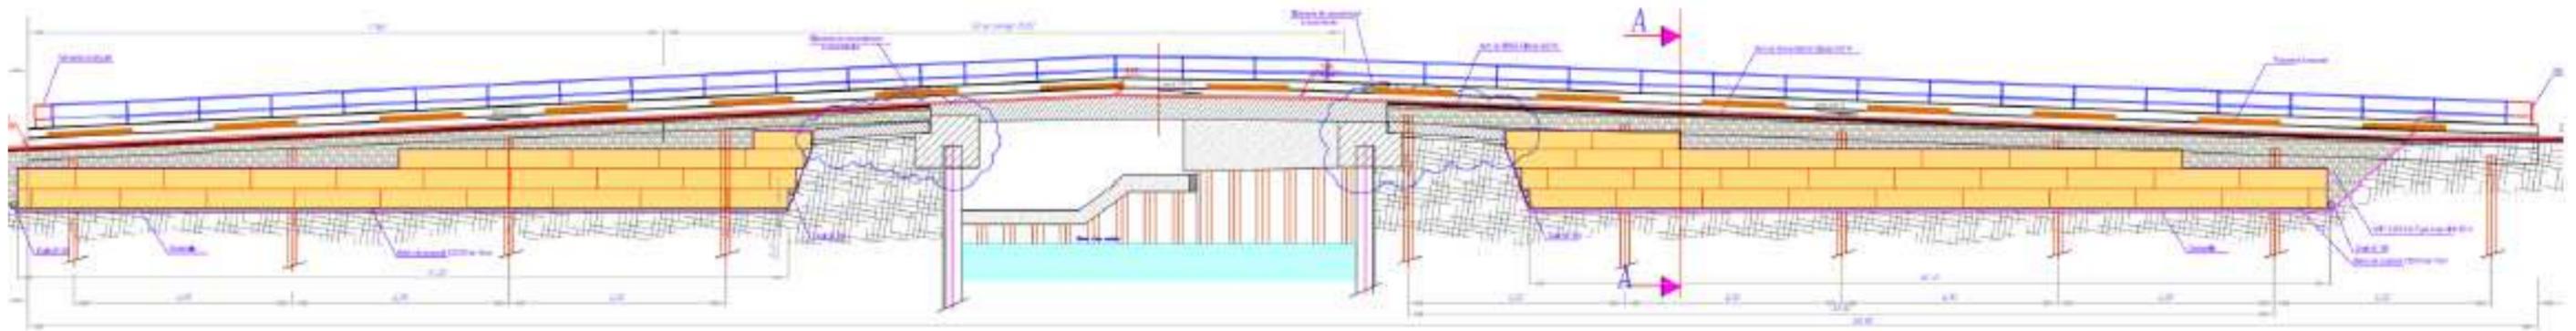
coupe longitudinale de l'ouvrage solution 1 remblai allégé
